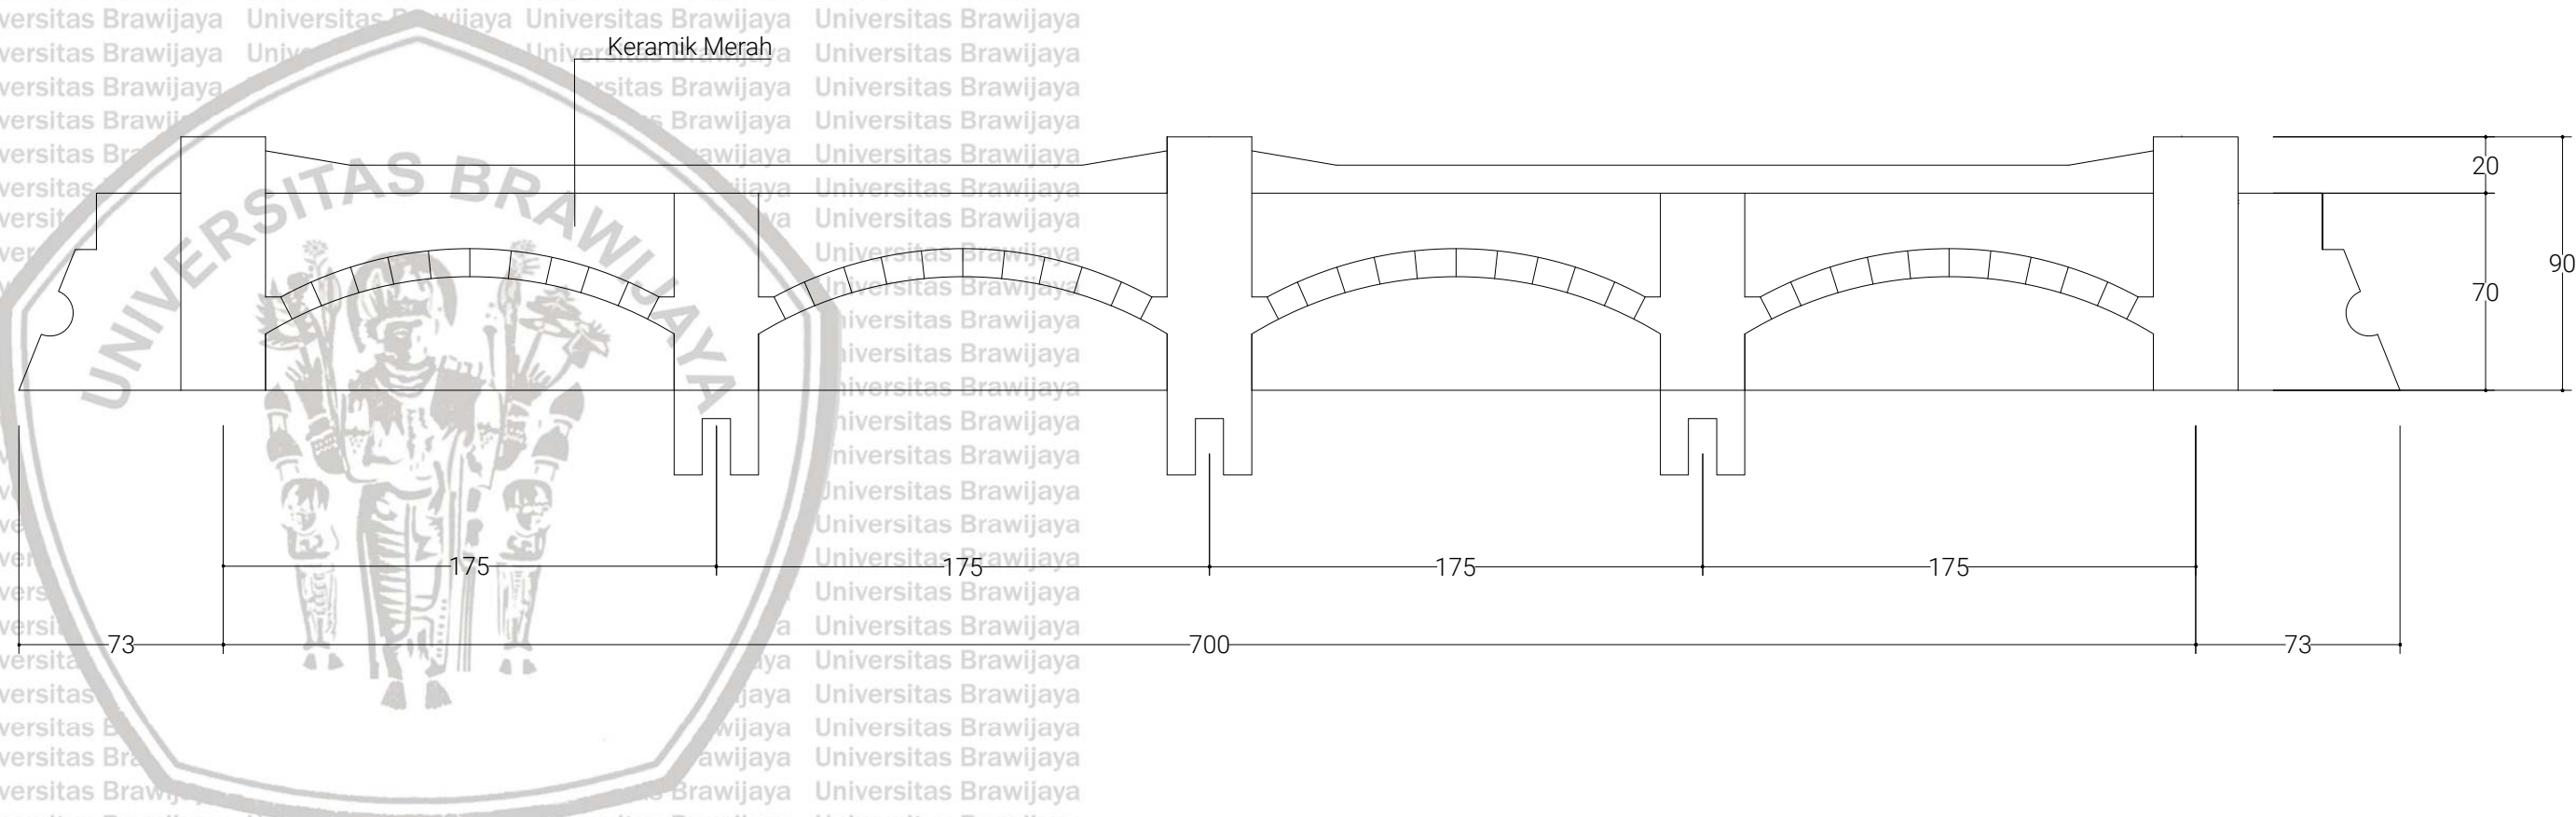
DETAIL ORNAMEN LUNETTE 1 STASIUN TAWANG
